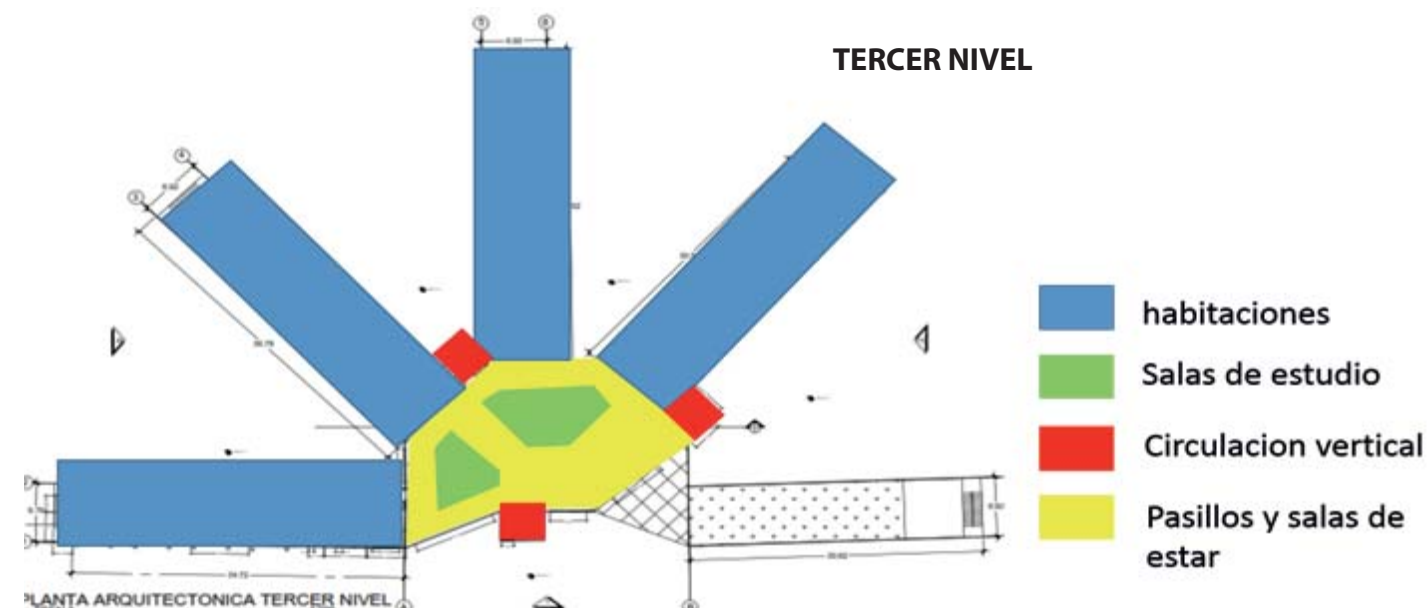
Distribución de la planta arquitectónica del tercer nivel
